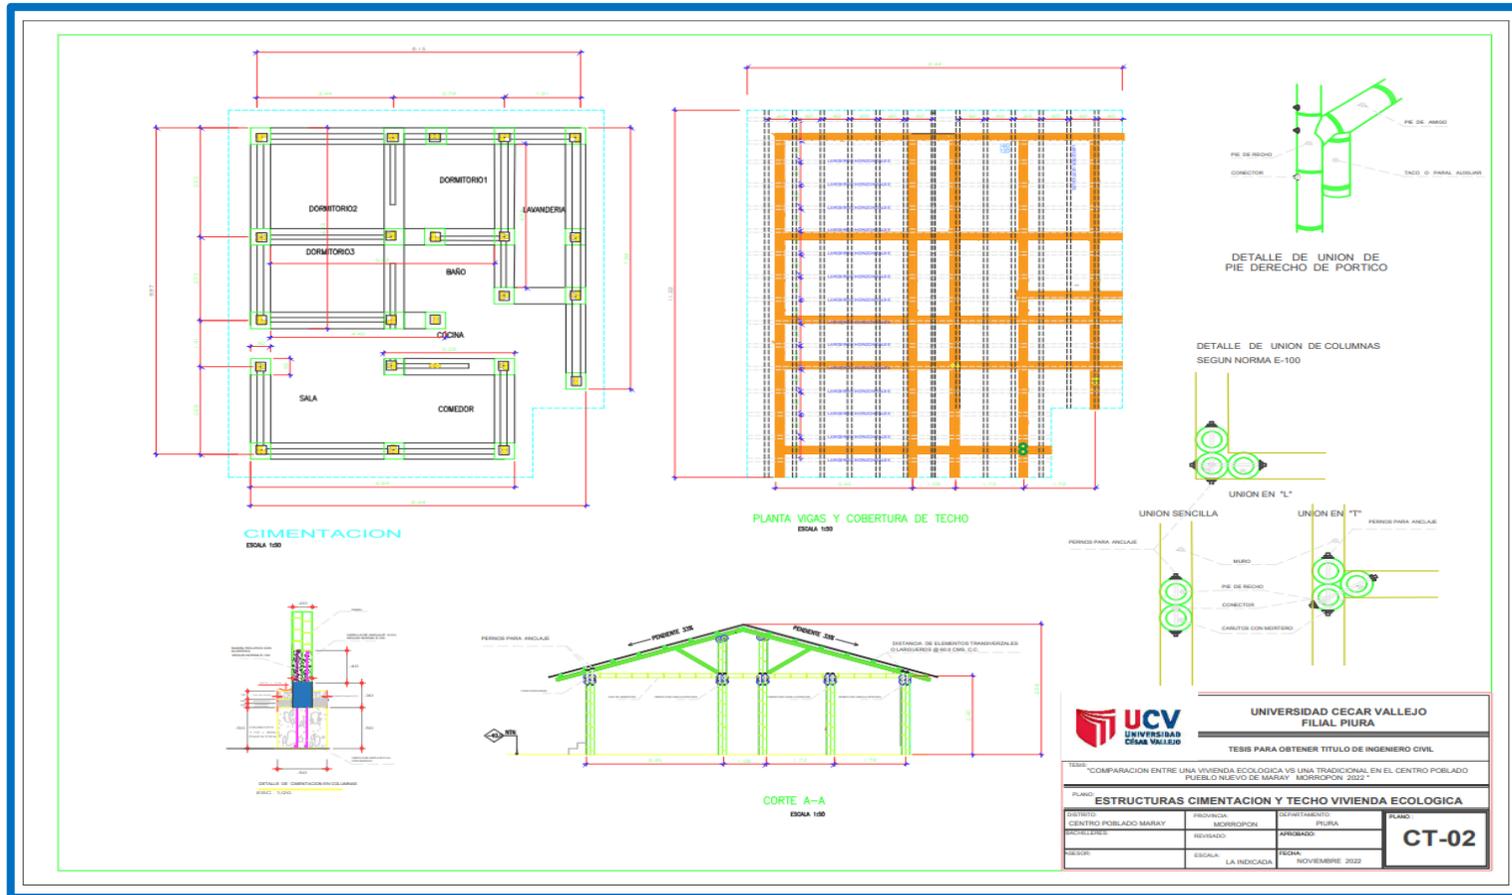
Plano de estructuras, cimentación y techo – vivienda ecológica (CT – 02).
